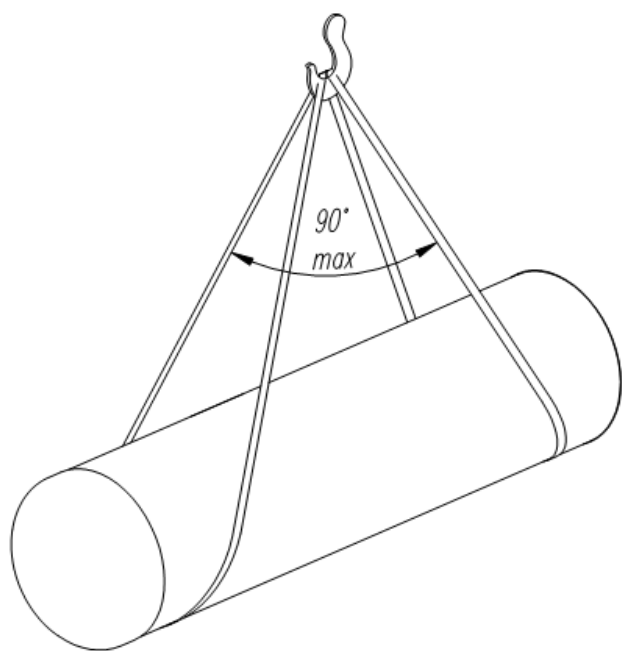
Схема строповки корпуса КНС длиной до 6 метров.
